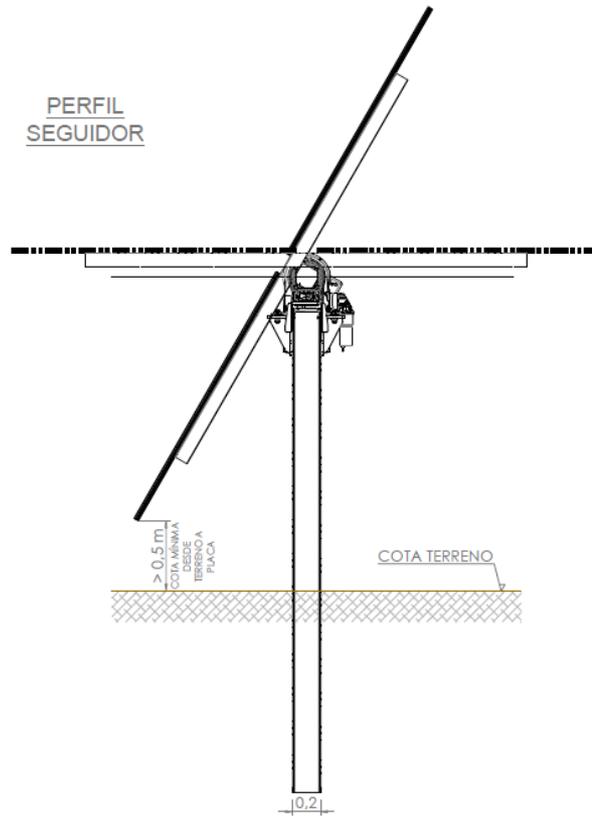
Detalle del perfil del seguidor hincado en el terreno
